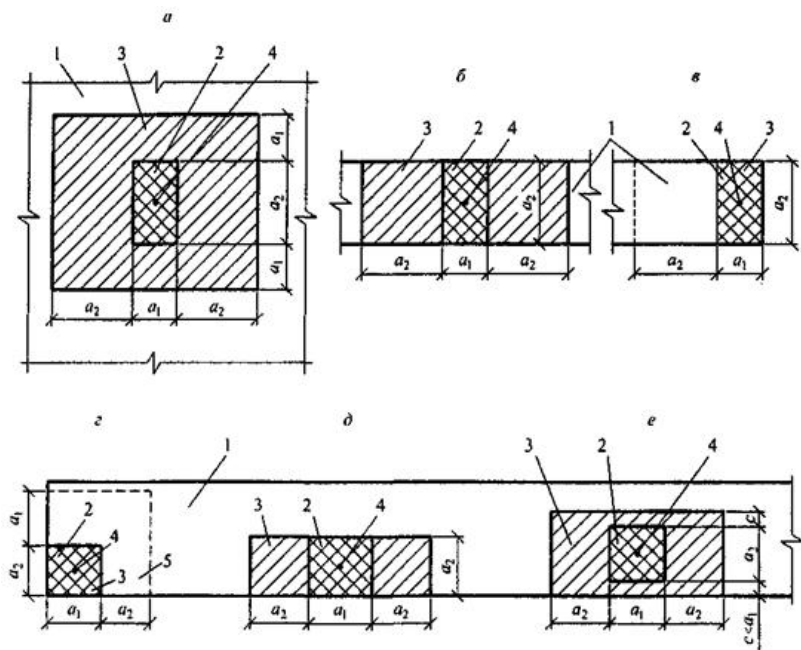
Схемы для расчета элементов на местное сжатие при расположении местной нагрузки: *a* – вдали от краев элемента; *б* – по всей ширине элемента; *в* – у края (торца) элемента по всей его ширине; *г* – на углу элемента; *д* – у одного края элемента; *e* – вблизи одного края элемента; 1 – элемент, на который действует местная нагрузка; 2 – площадь смятия $A_{b,loc}$; 3 – максимальная расчетная площадь $A_{b,max}$; 4 – центр тяжести площадей $A_{b,loc}$ и $A_{b,max}$; 5 – минимальная зона армирования сетками, при которой косвенное армирование учитывается в расчете
